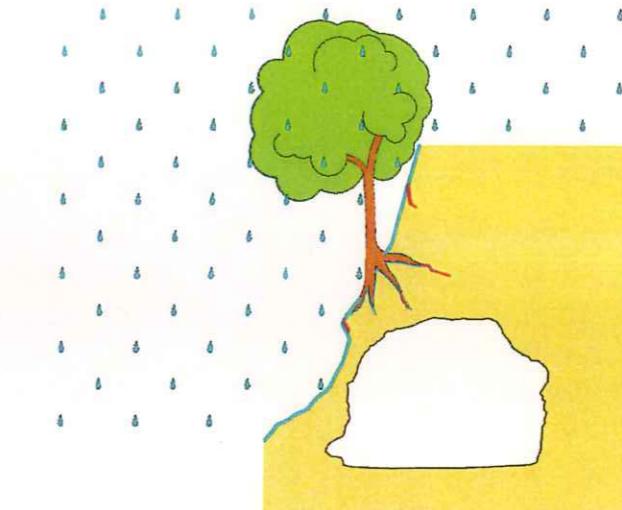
ひび割れに雨水等が入り込むイメージ図
